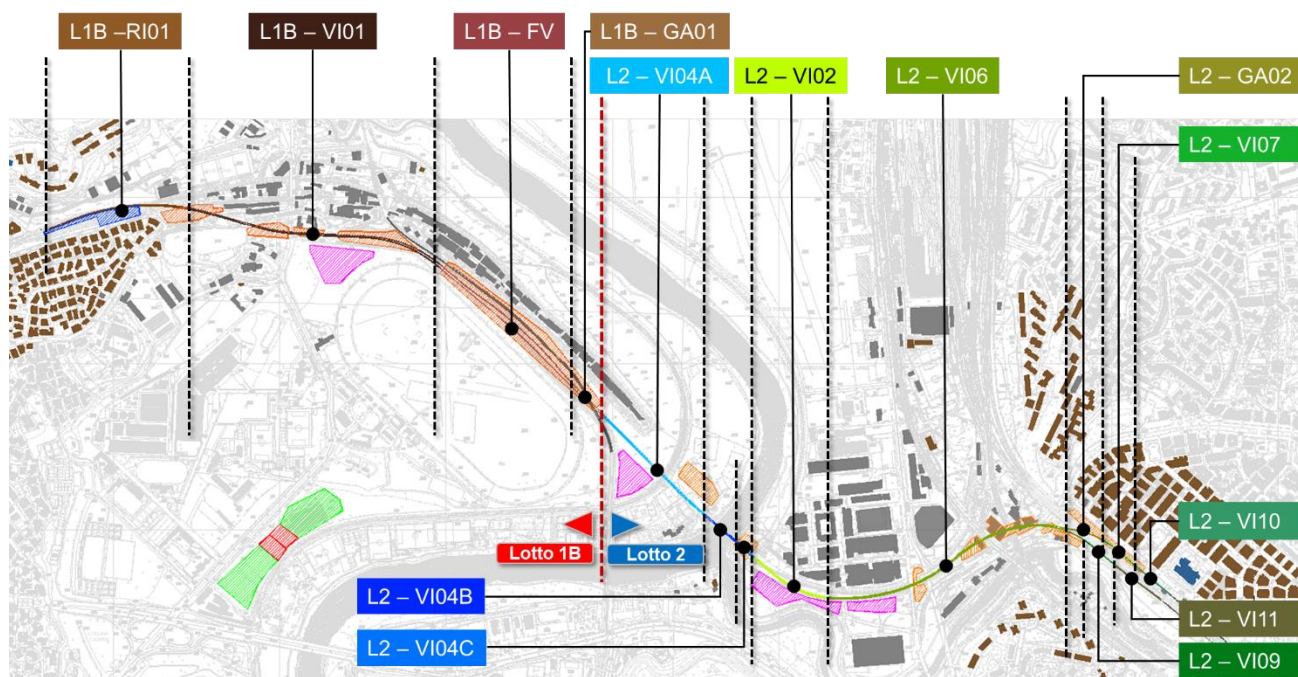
Lotto 1B e Lotto 2: Quadro complessivo delle opere in progetto
